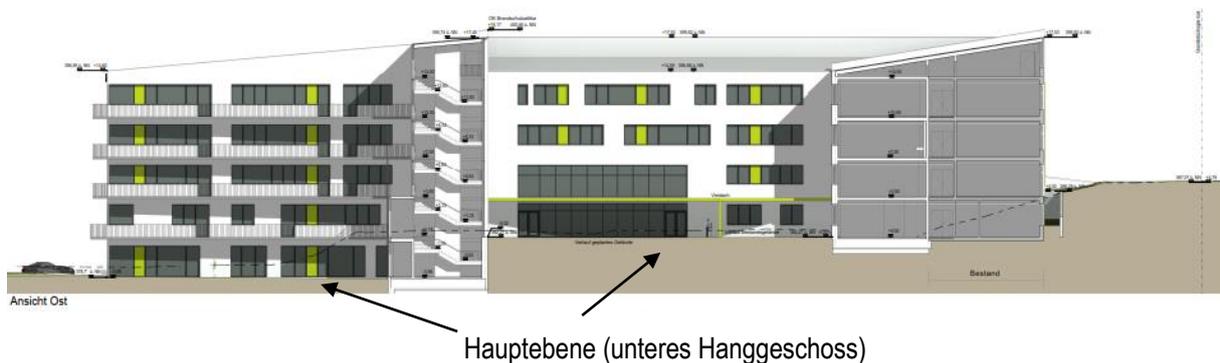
Gebäude West: Ostansicht mit Schnitt durch Gebäude Nord⁷
